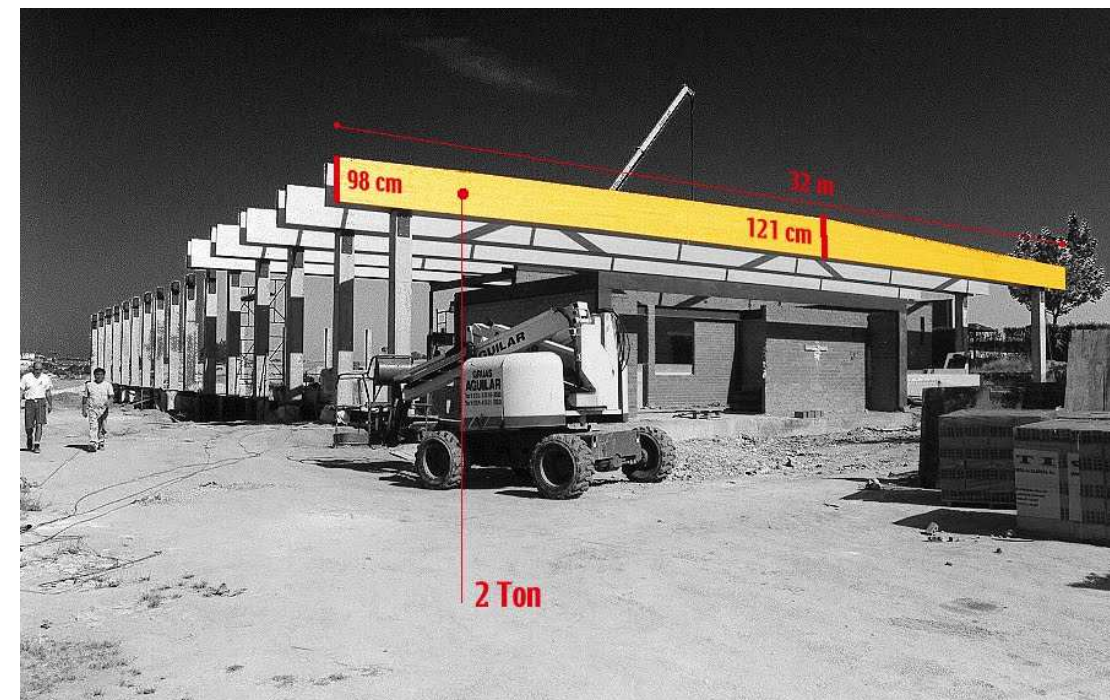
Características de las vigas de cubierta. Fuente: artearquitecturaydiseño.blogspot.com
